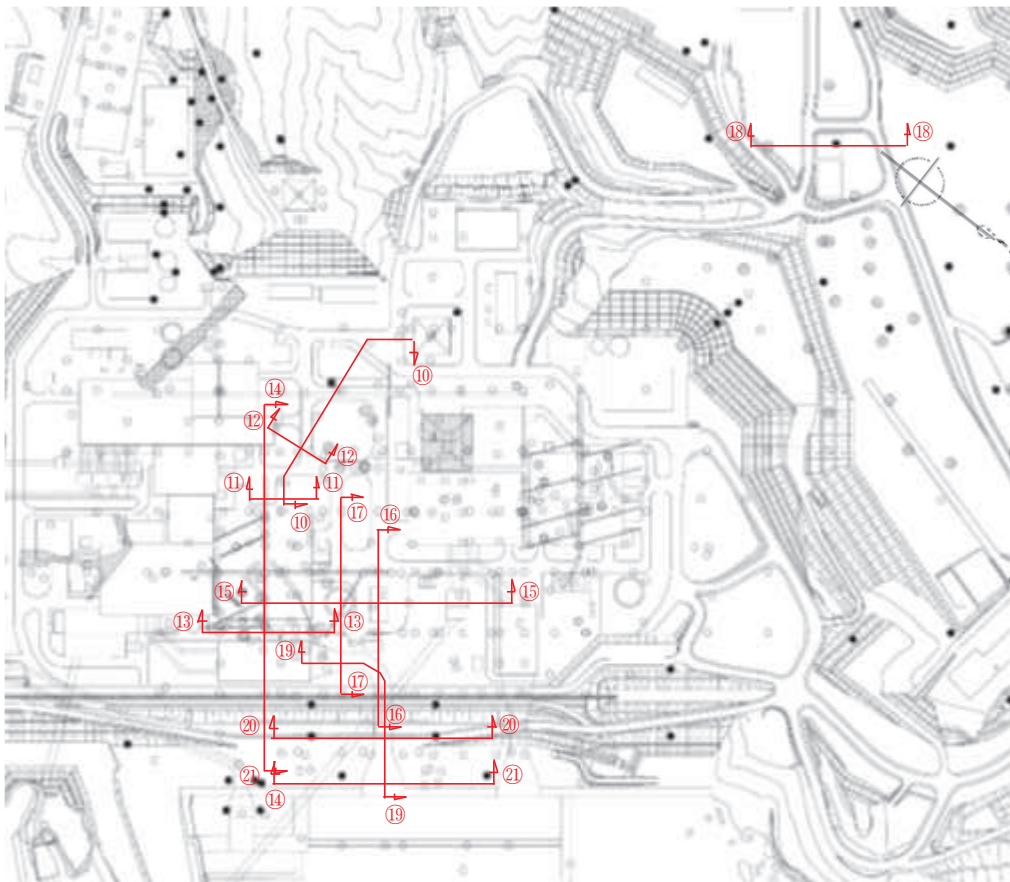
(2) 地質断面图位置 (⑩—⑩断面~㉑—㉑断面)
